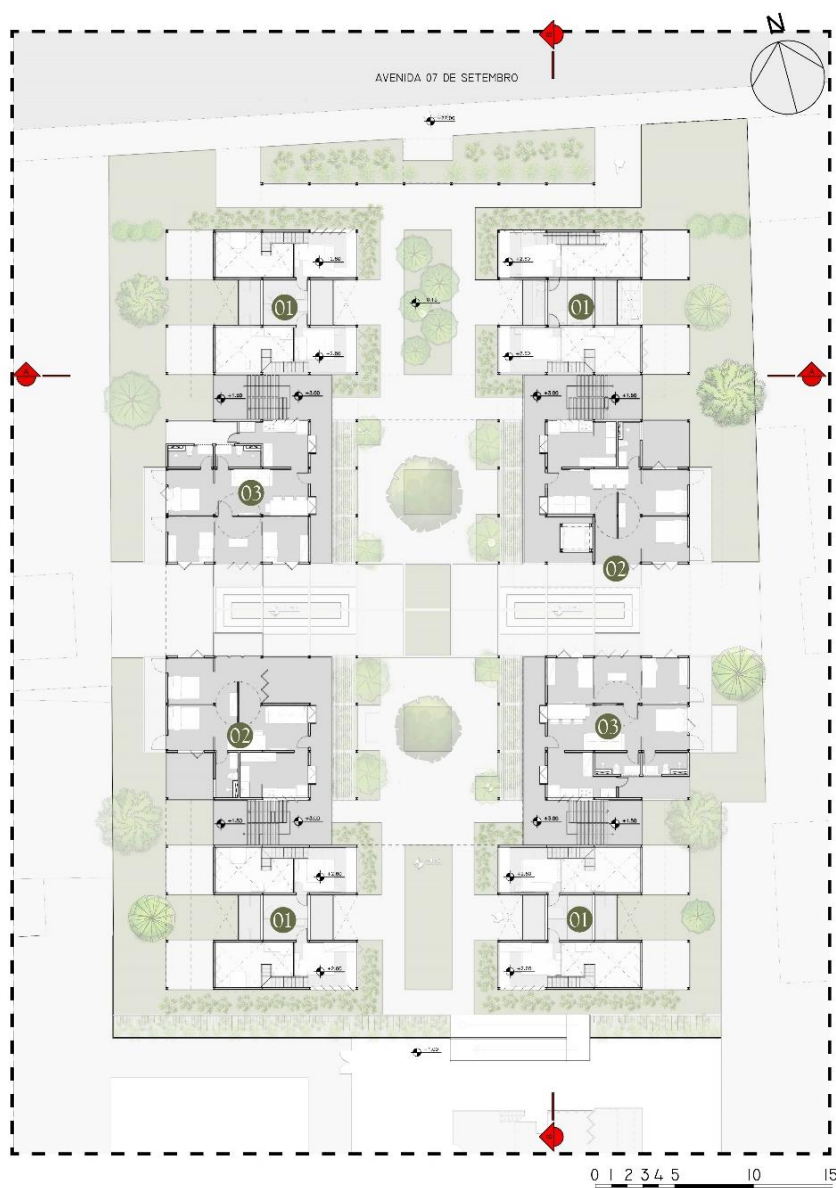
Planta Baixa Bloco A - Pav. 01. Fonte: Acervo do Autor.
